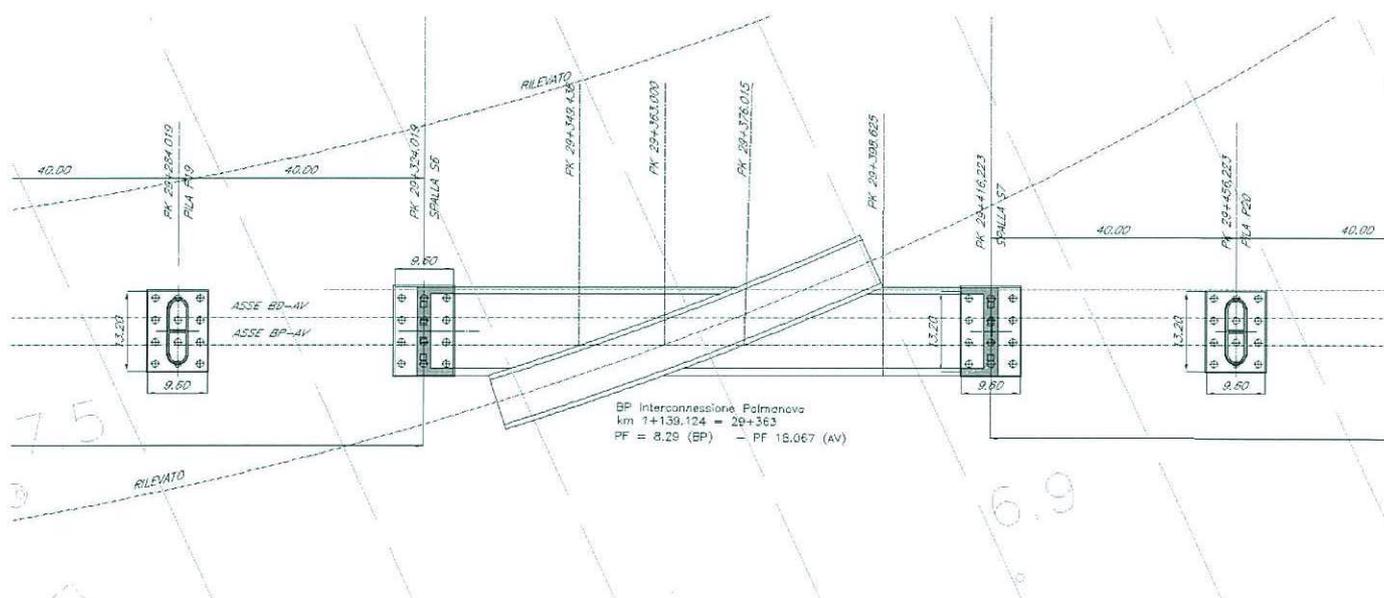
Pianta fondazioni dello scavalco della Interconnessione Palmanova.
